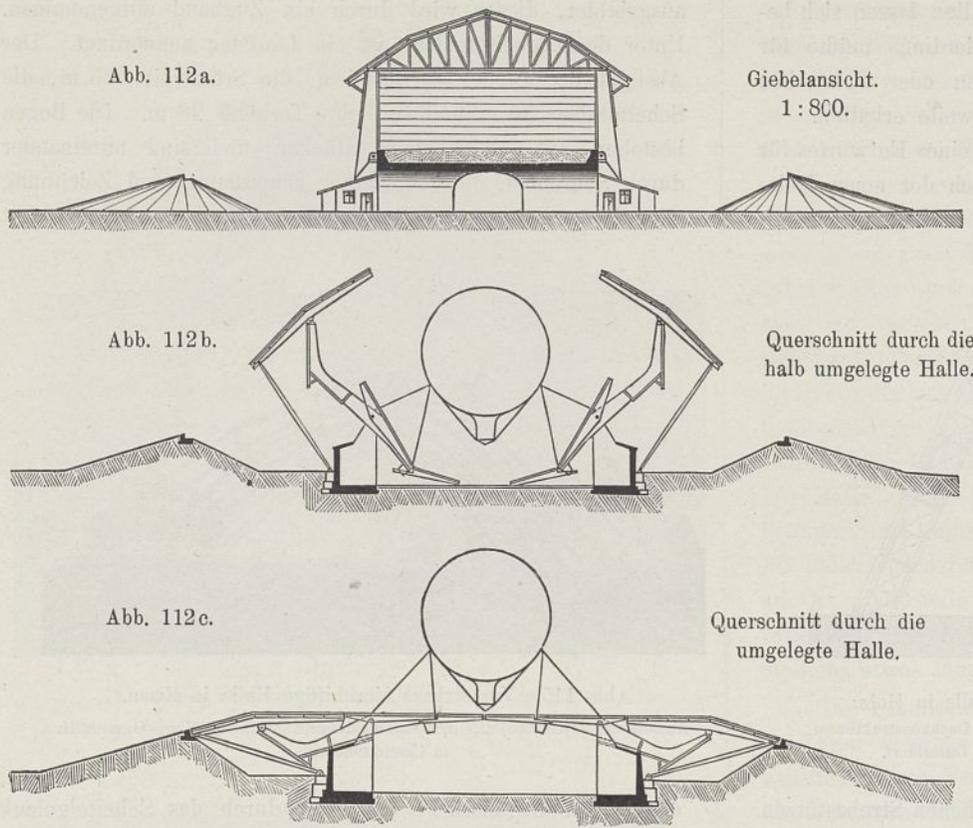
a bis c. Einschiffige versetzbare Halle in Eisen.
